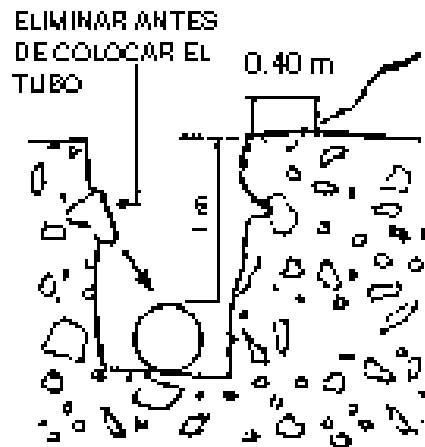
Parámetros Mínimos Para Colocación de Tuberías y de Material Excavado de Zanja
